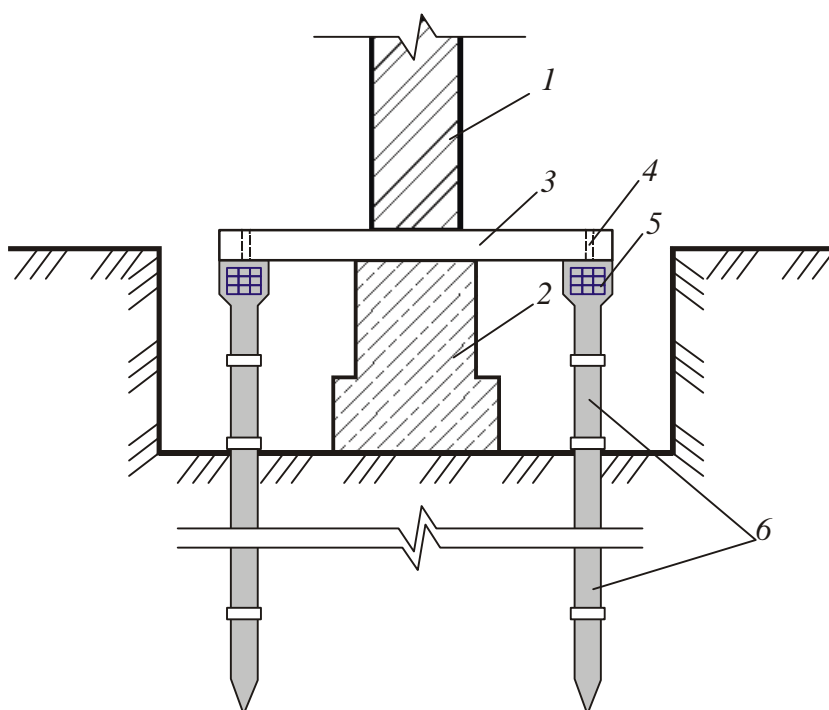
Усиление фундаментов с помощью задавливаемых металлических свай:
